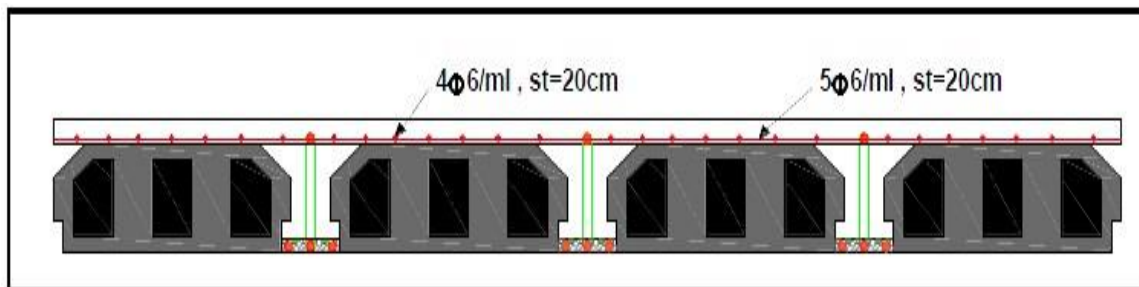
Disposition constructive des armatures de la dalle de compression
